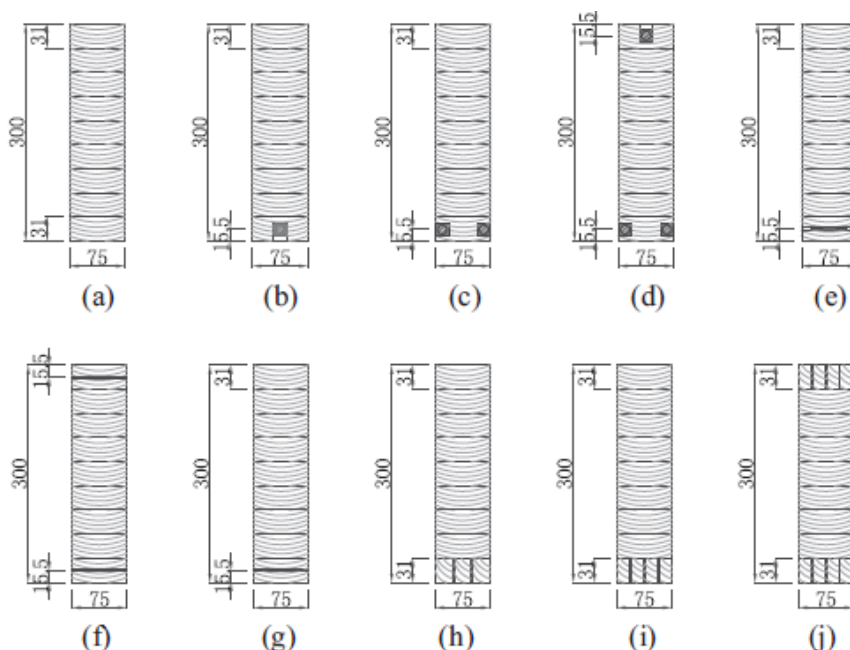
Configuraciones de refuerzo de vigas laminadas (Fuente: Yang et al. 2016).³²²
